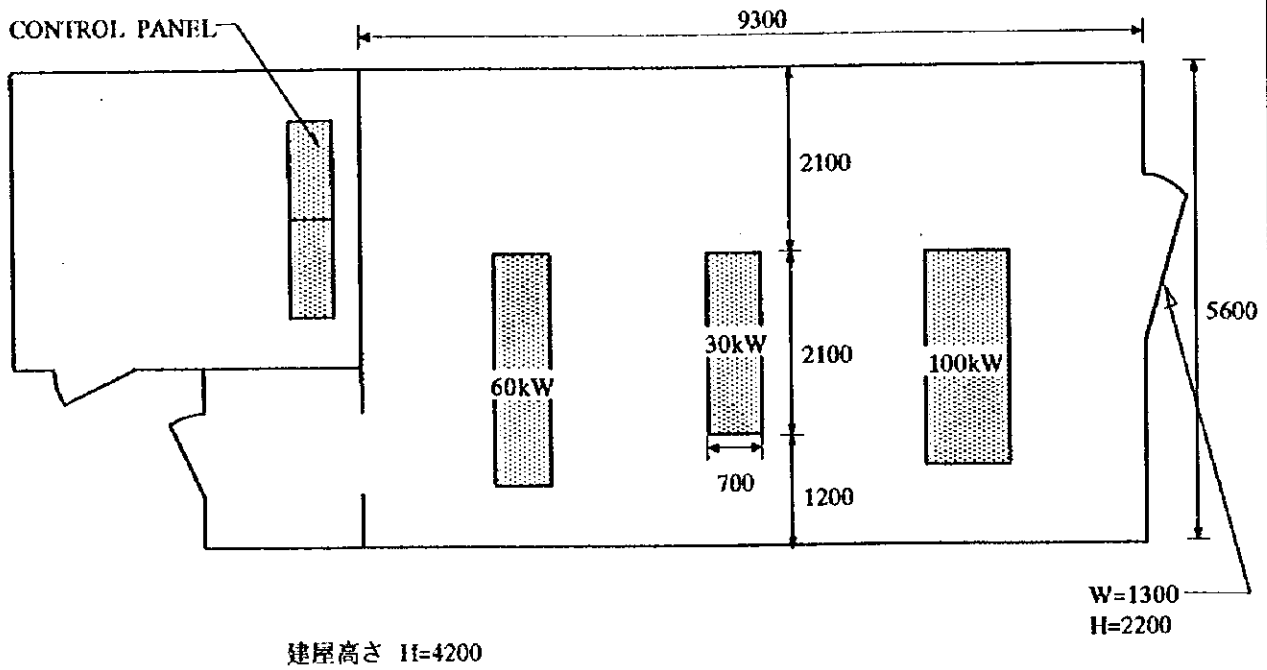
27 Erdenekhairkhan村の機器配置図
